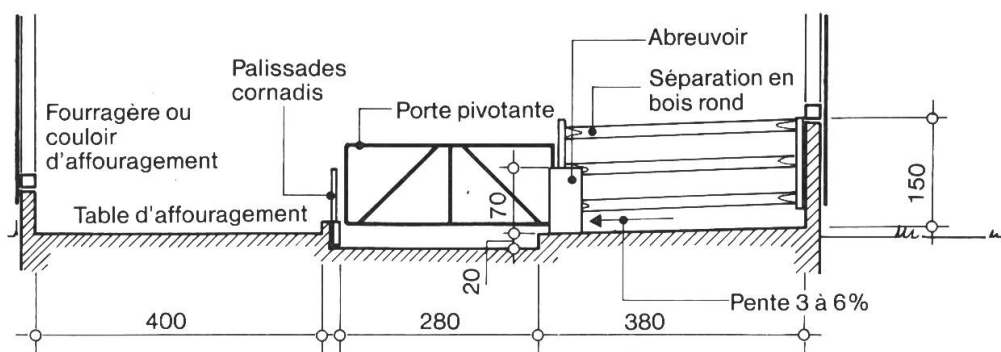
système de stabulation libre sur plan incliné en 1 rangée, couloir d'alimentation sur le côté. Boxes pour 10 animaux d'élevage ou d'engraissement. Les jeunes bêtes pèsent 135–370 kg poids vif, les bêtes plus âgées: 345–550 kg poids vif.
